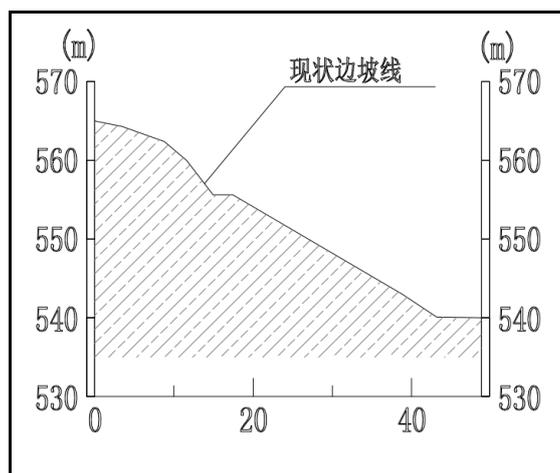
现状露天采场 P5 边坡代表性剖面图
